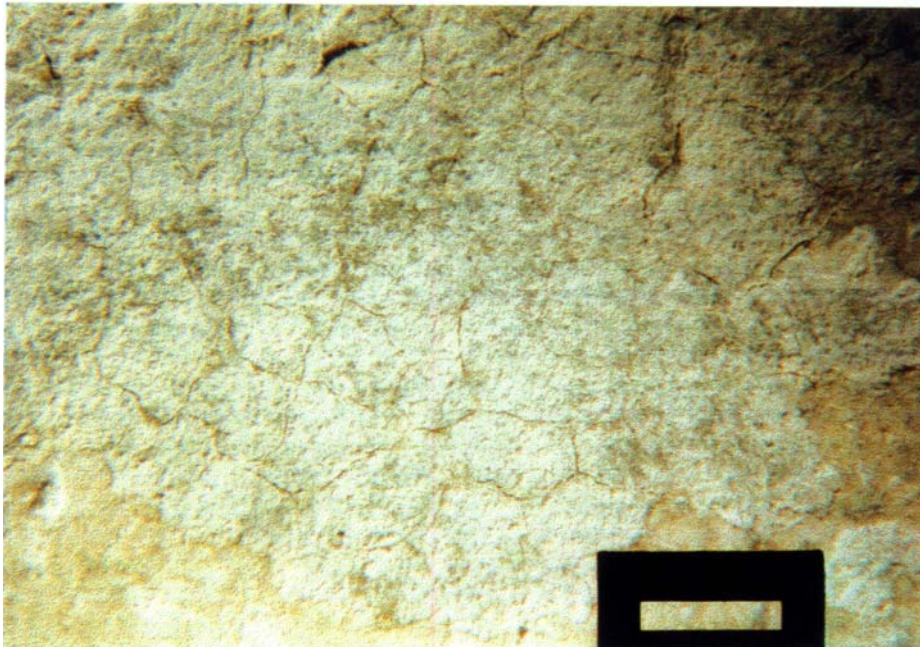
CEM III/B 32,5-NW/HS-Schaummörtel + MgSO₄ nach 1 1/2 a Wasserlagerung
